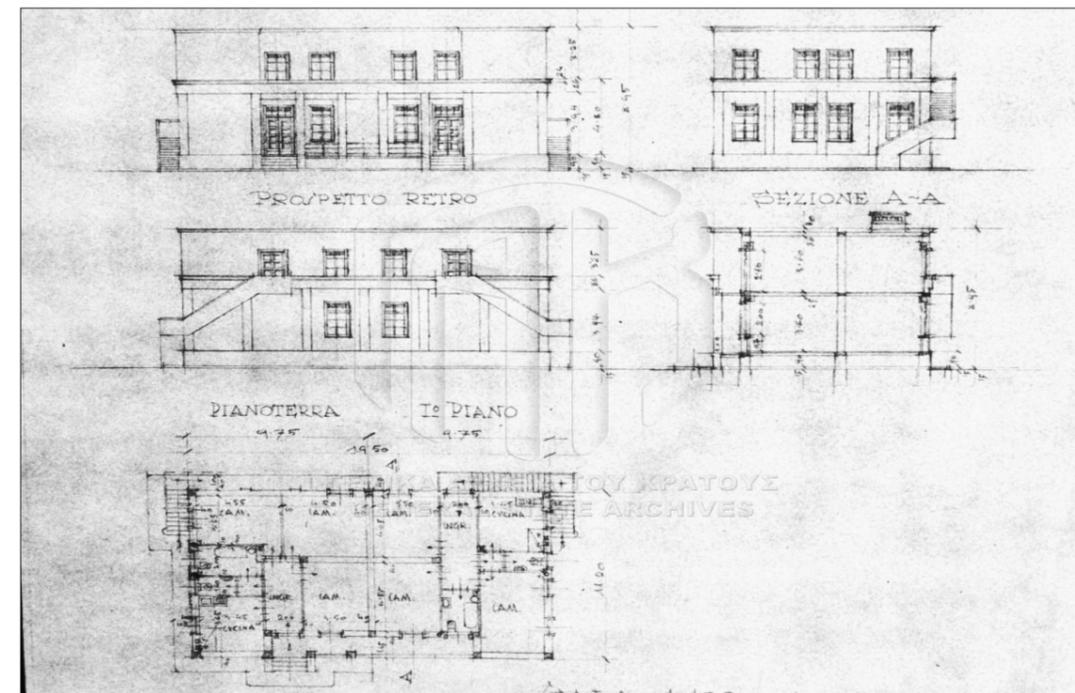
casa operai A, pianta sezione e prospetti sc. 1:100
